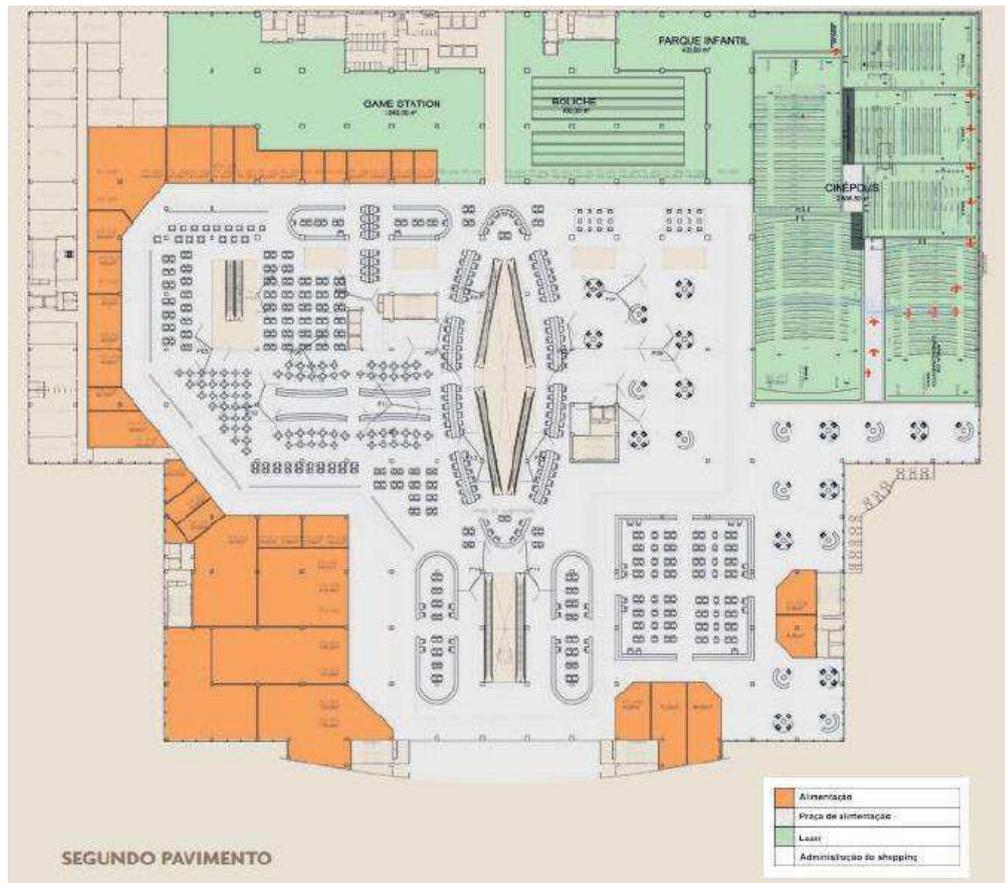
A. Planta baixa - Segundo Pavimento. [6]
